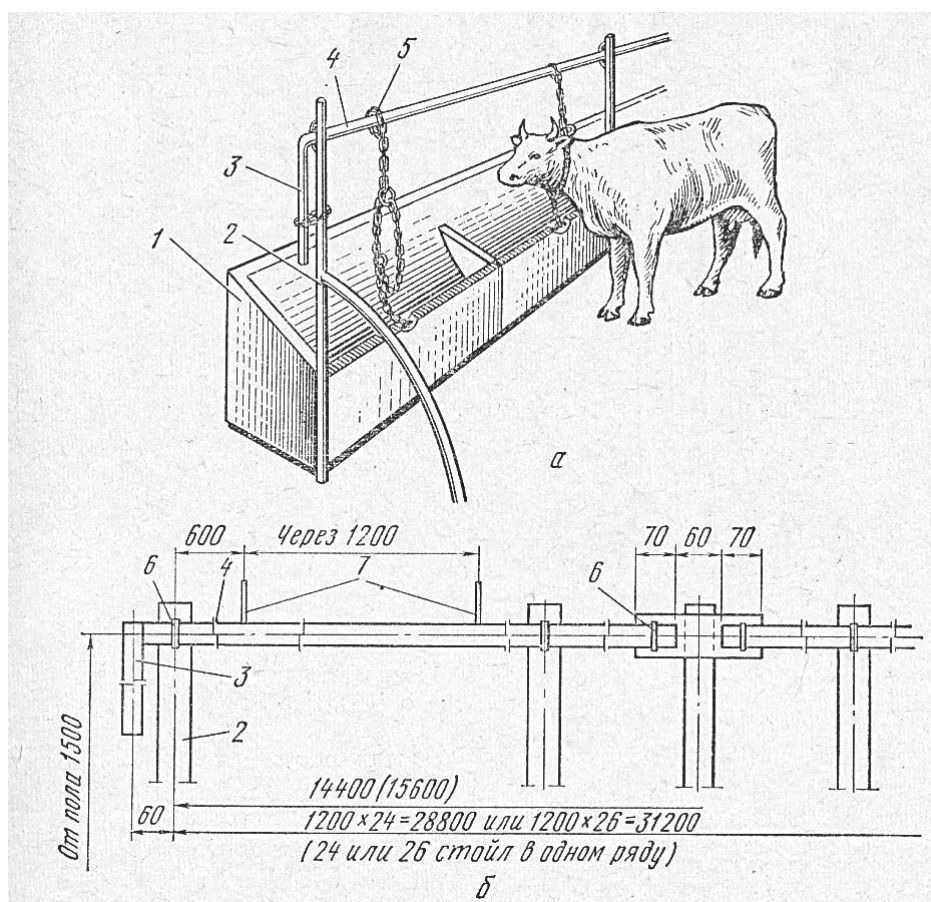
Монтаж механической привязи: 1 – кормушка; 2 – стойка; 3 – поворотный рычаг; 4 – продольная штанга; 5 – привязная цепь; 6 – скоба; 7 – крючки
